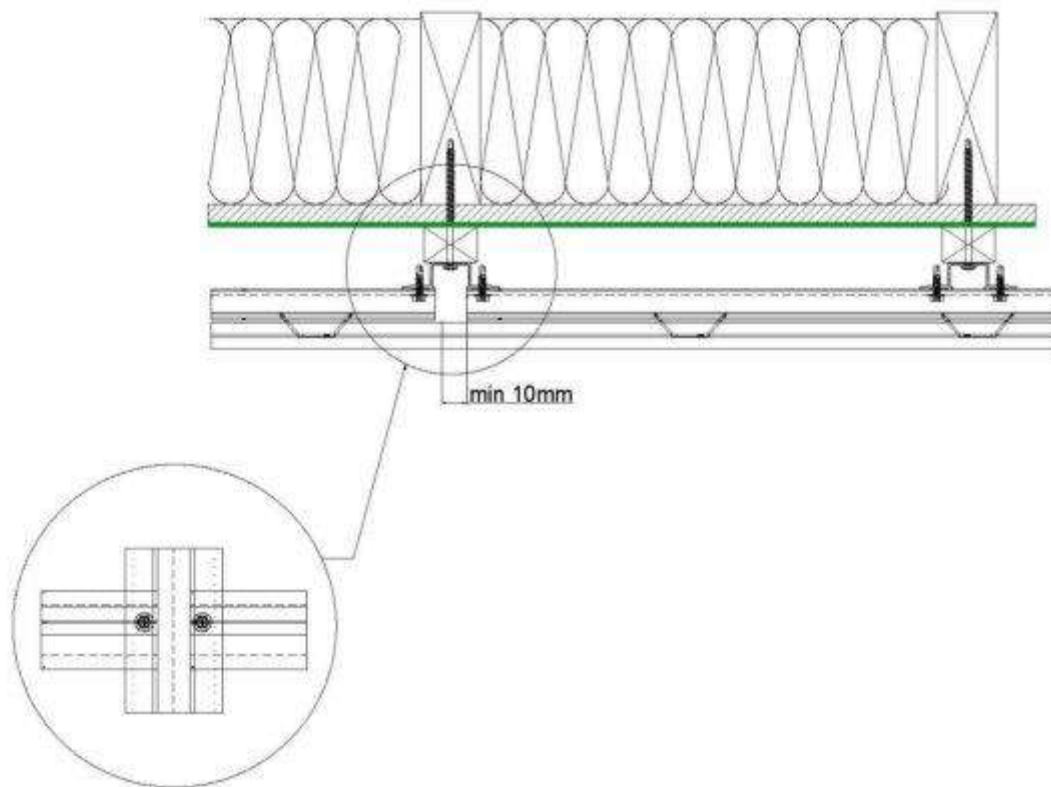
Exemple d'écissage rail horizontal conforme au Cahier du CSTB 3194_V3
